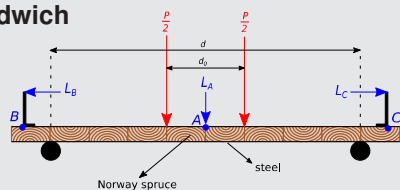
Essai de flexion 4-points sur une poutre sandwich (Perret et al, 2018)
